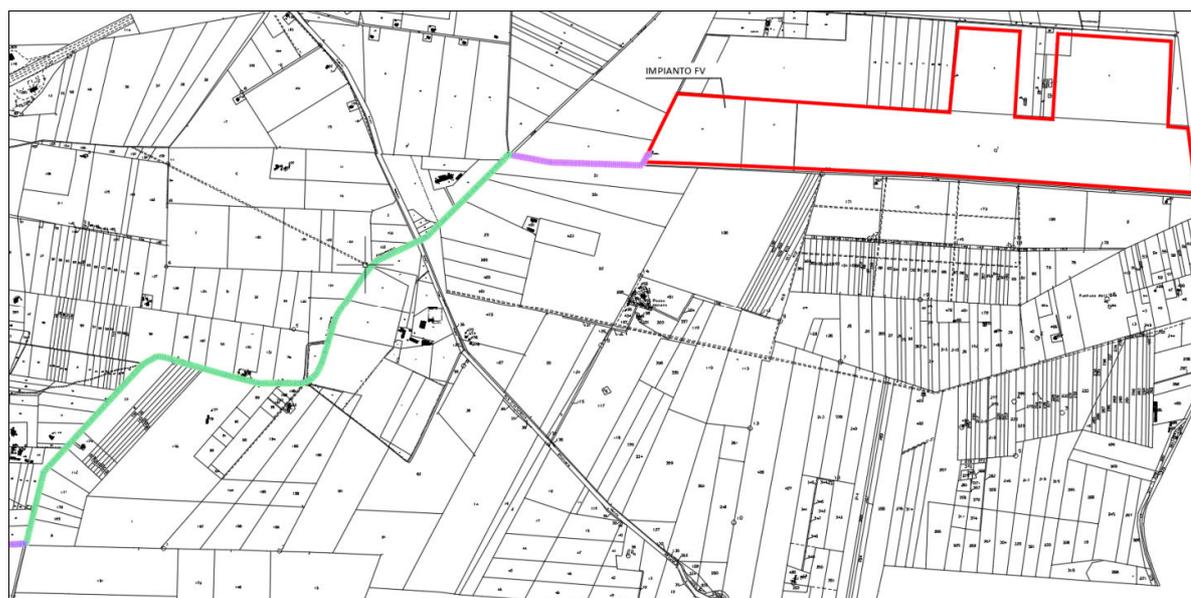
Stralcio 1 da planimetria catastale - percorso cavidotto MT
